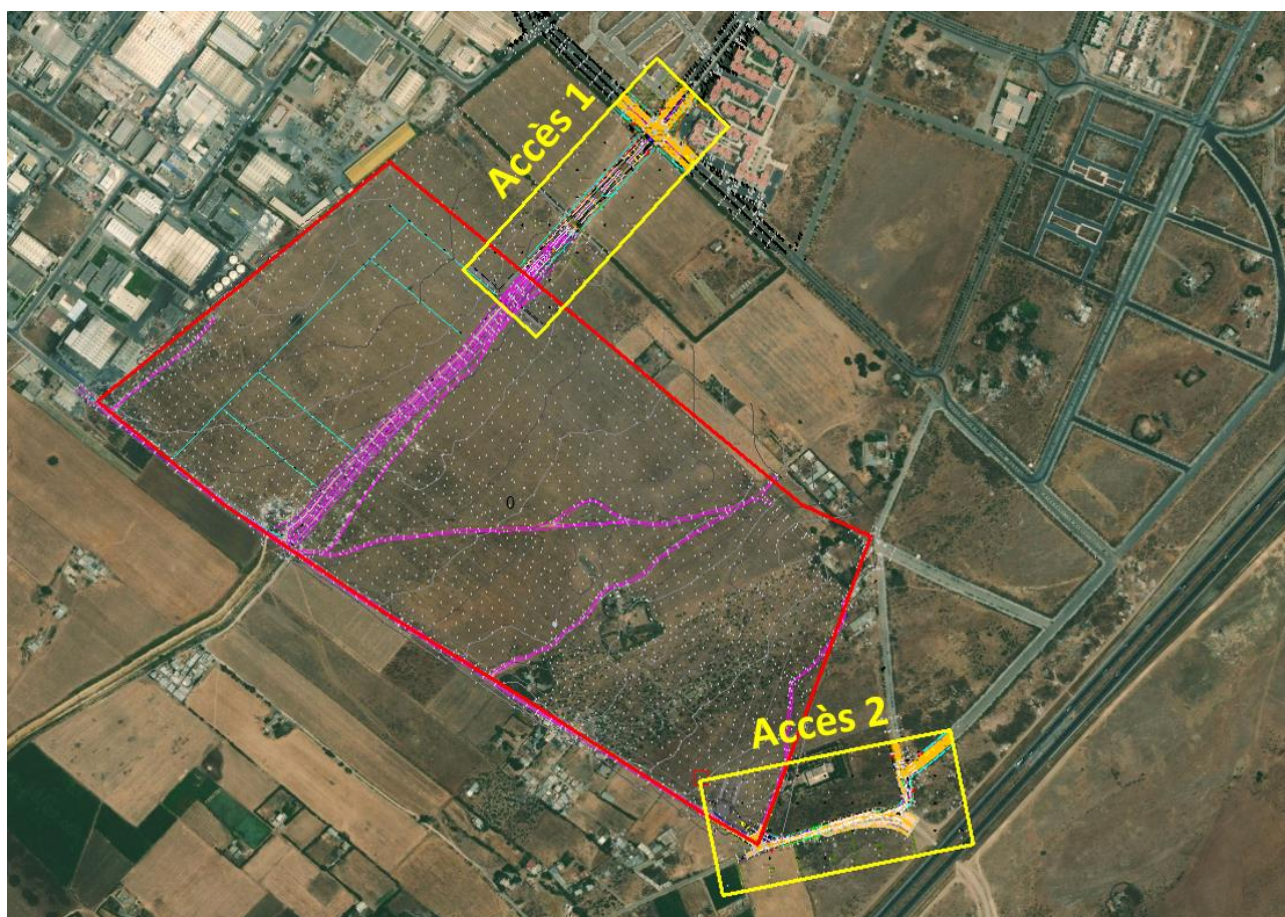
localisation des tracés en plan des voies d'accès et carrefours – Extension de la ZI Had Soualem.
